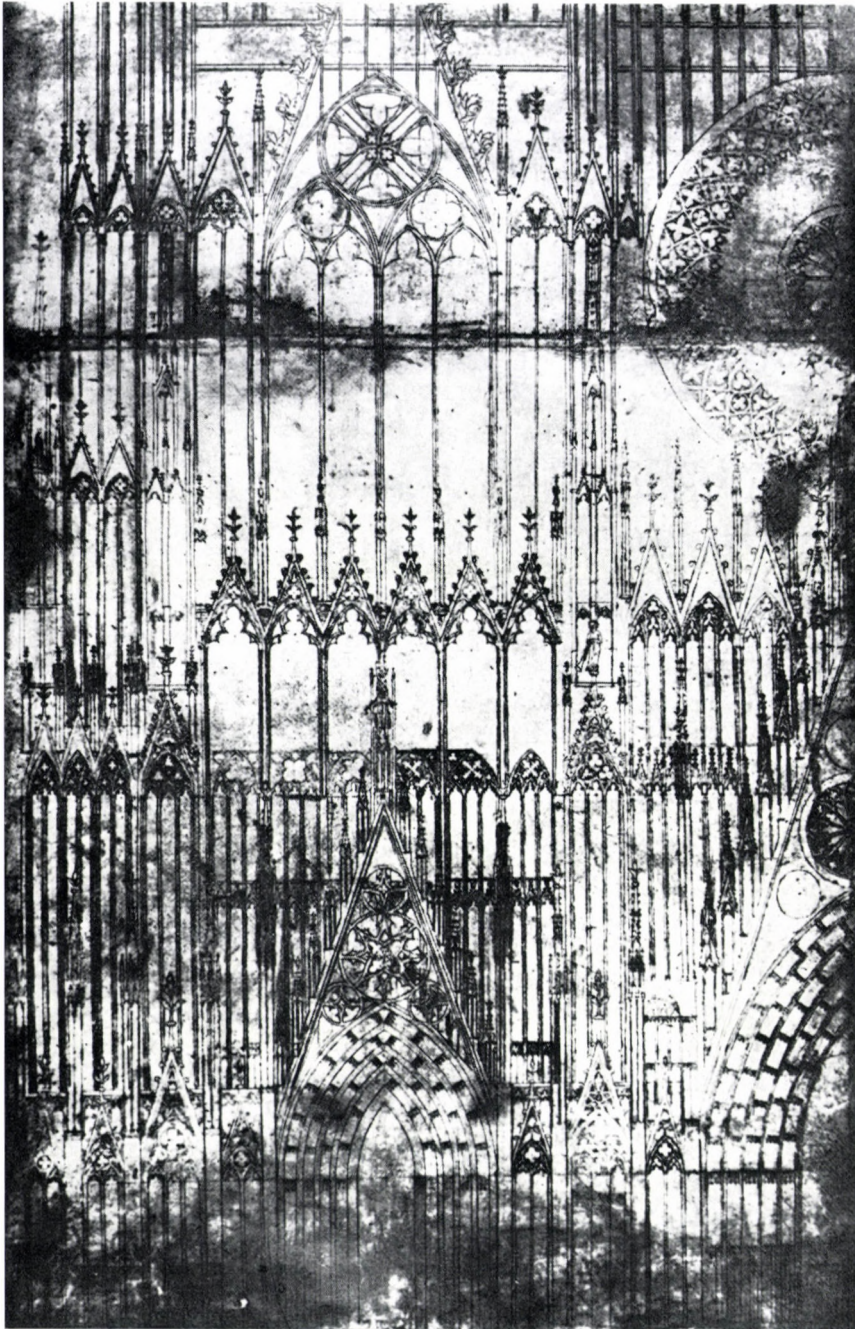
Straßburg, Münster, Fassadenriß B, Untergeschosse (nach Wortmann: Westbau)
